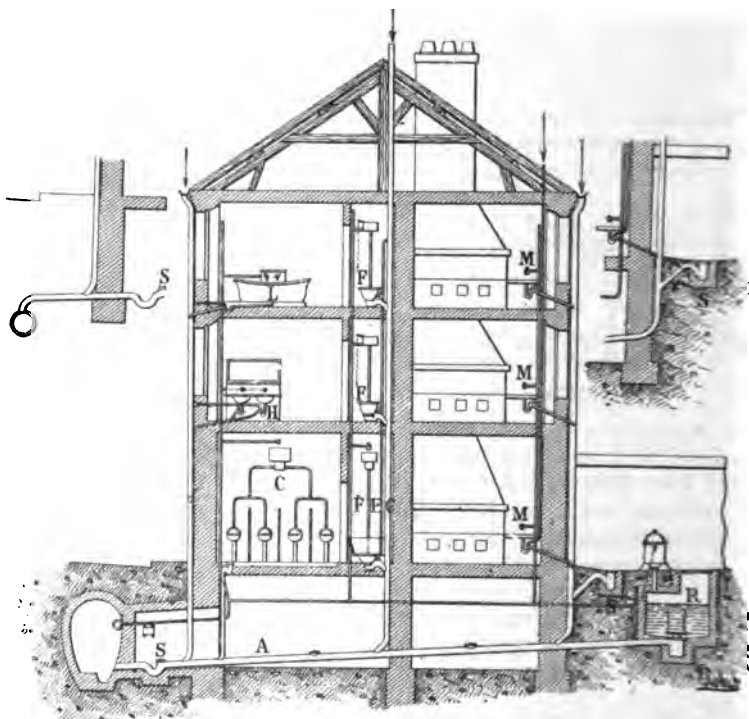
Coupe d'une maison assainie et canalisée pour le système du tout à l'égout.
